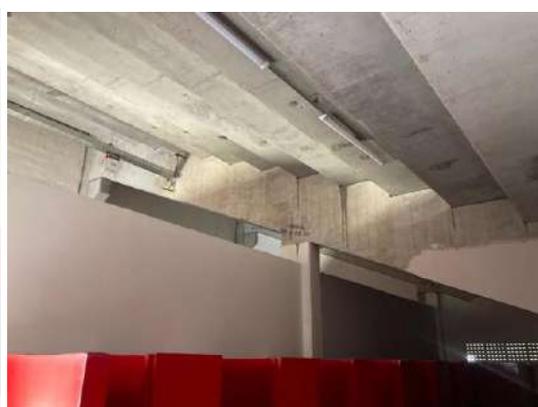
e 66: Estrutura pré-moldada quase toda aparente
